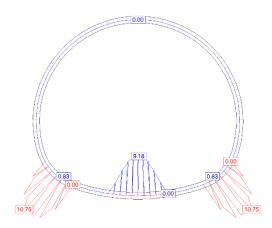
Secção TV.1. Armaduras de cálculo de flexão (cm2/m)
